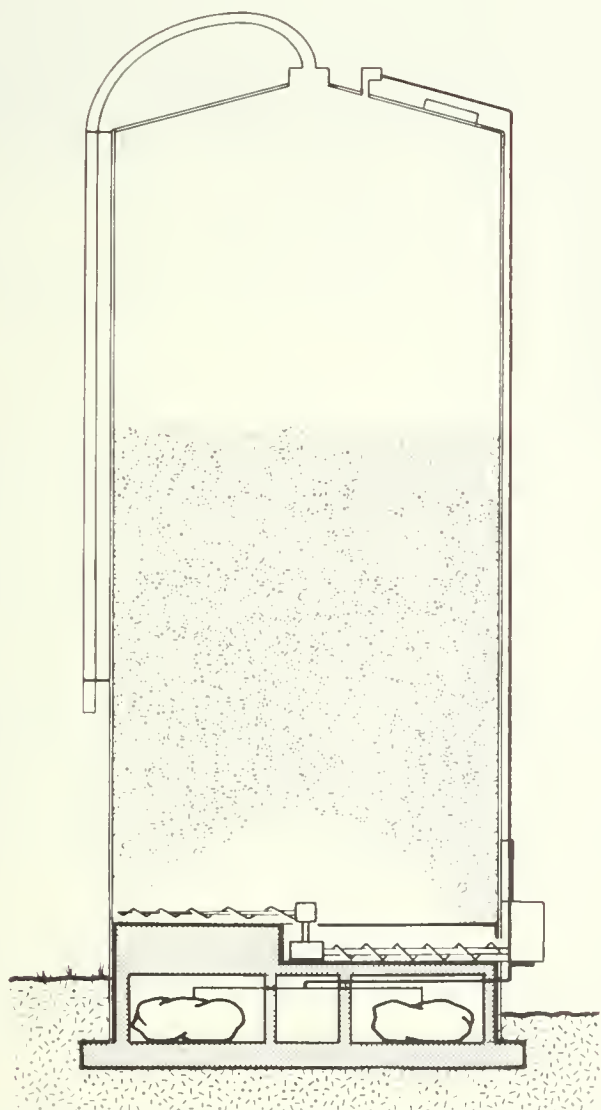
Un autre endroit pour l'installation des sacs de respiration est à l'intérieur de la fondation.
